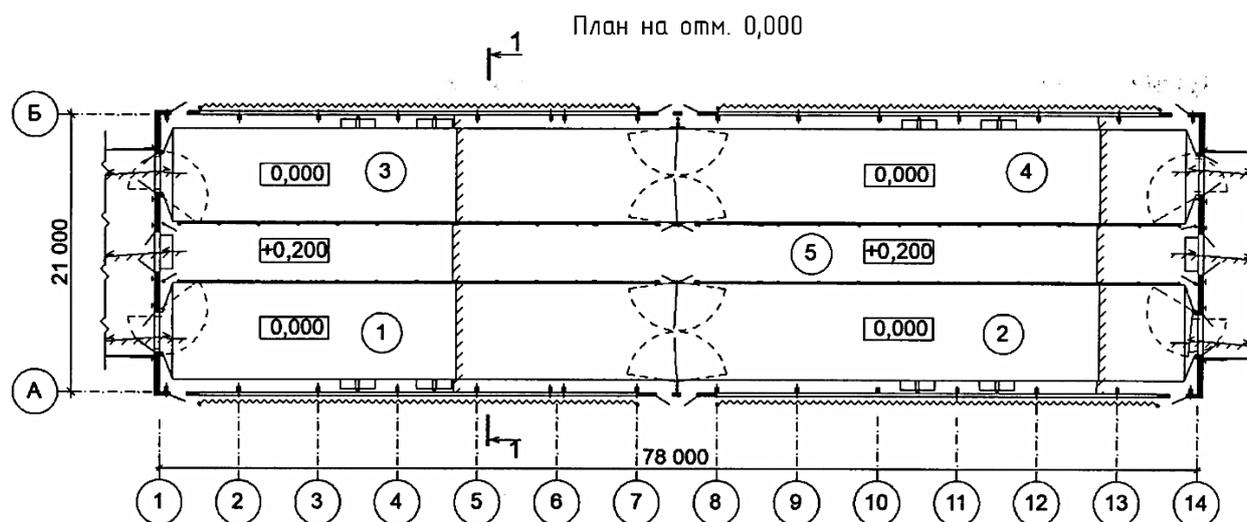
План здания для содержания сухостойных коров на 200 голов:
